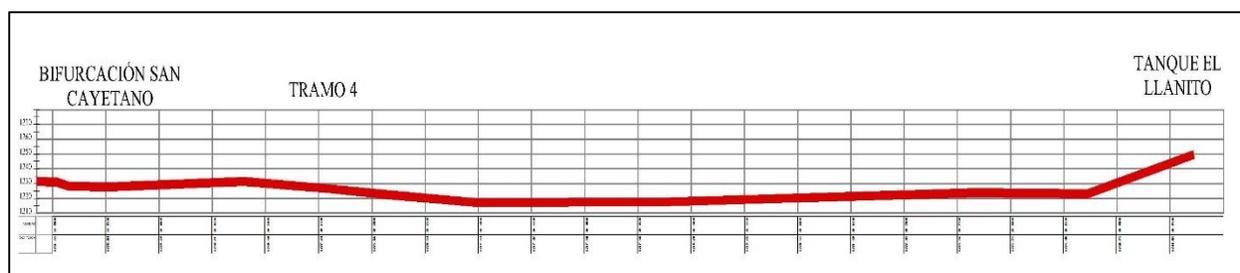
Perfil del terreno tramo bifurcación denominado San Cayetano- tanque El Llanito. Fuente: Pasante del proyecto.
